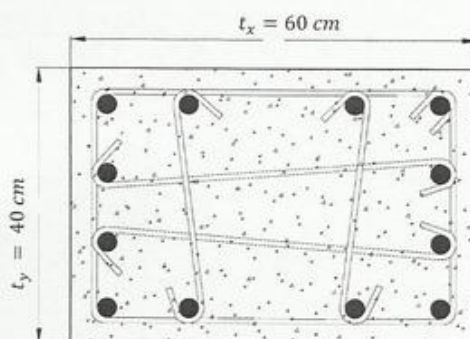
Colocación adecuada del acero transversal en columnas (los ganchos se doblan hacia el centro de la columna)
